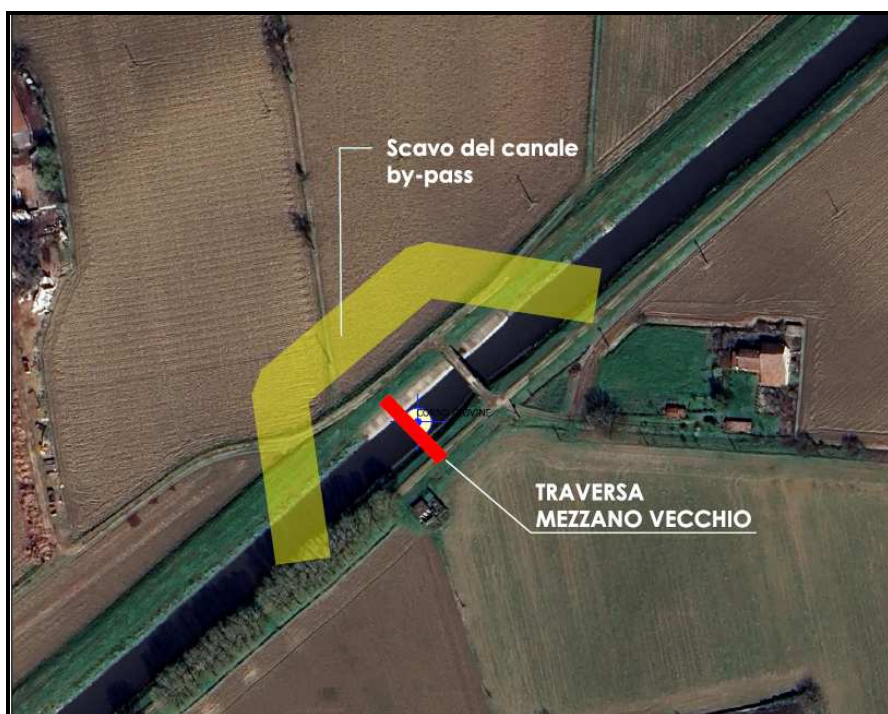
Planimetria località “Mezzano Vecchio” sito in esame.
